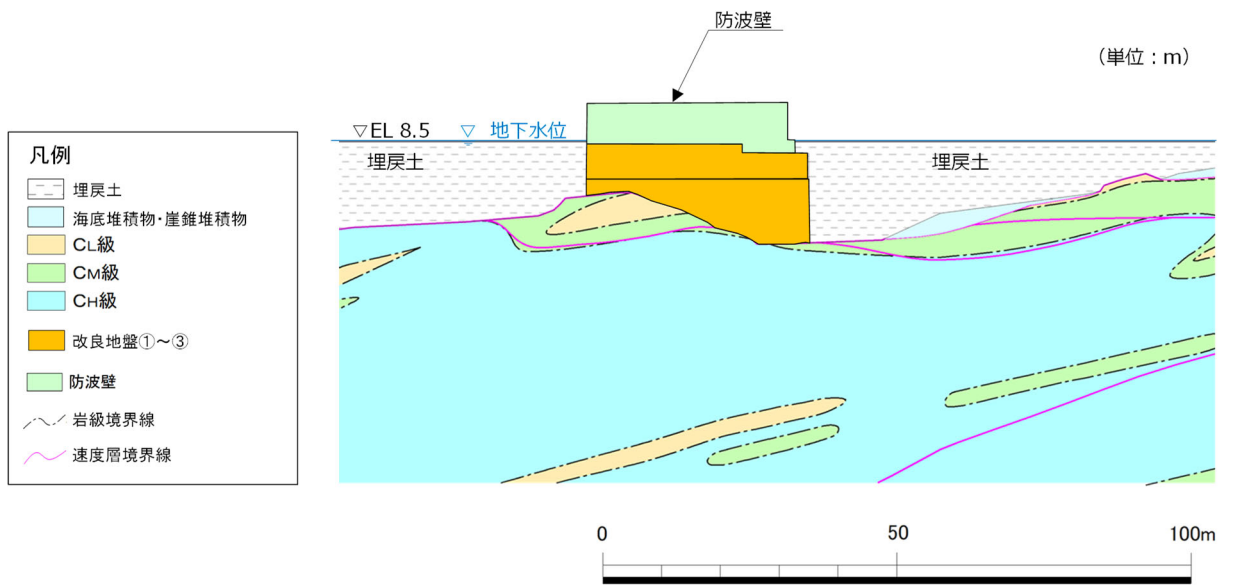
防波壁（逆 T 擁壁）の横断面図（⑦-⑦断面）
